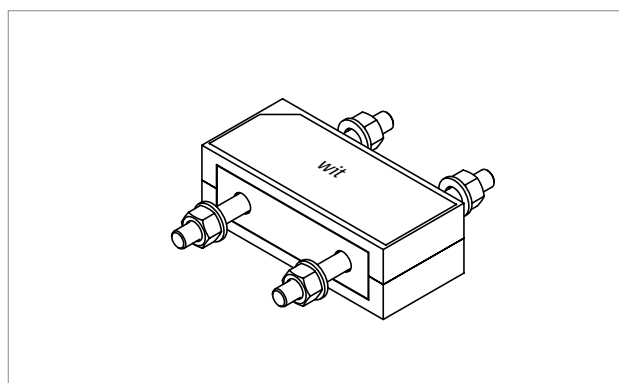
Schöck Isokorb® T type S-N-D22: Doorsnede
